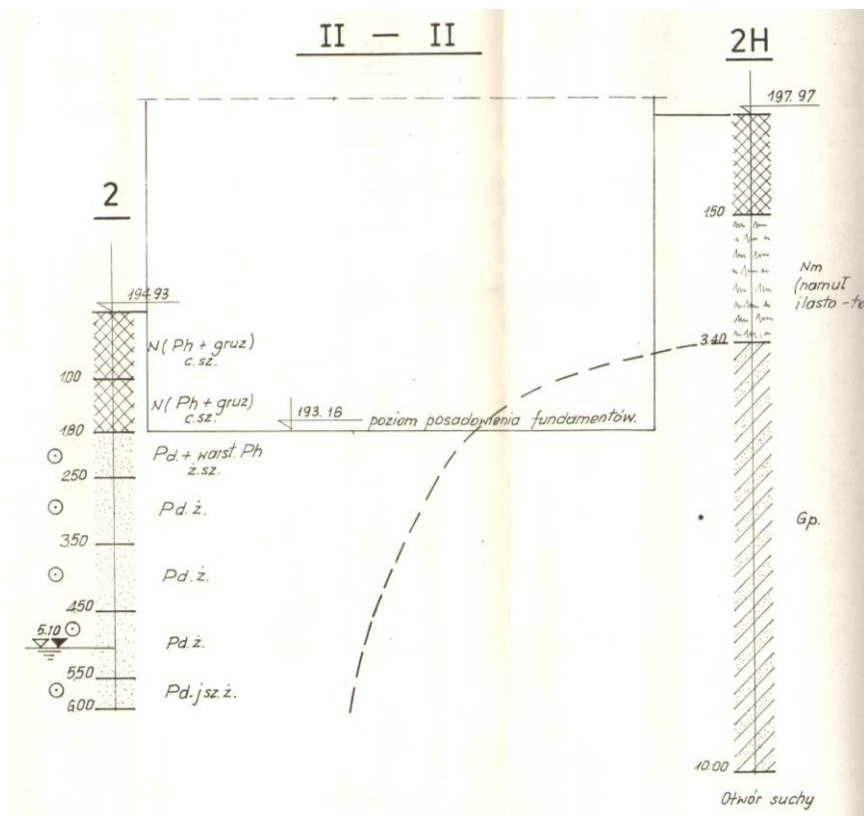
Fundament pod przyporą południowo zachodnią
